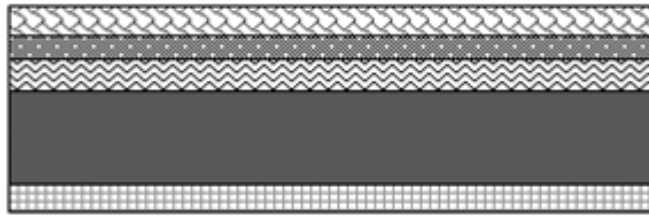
Coupe verticale du Plancher en dalle pleine.
